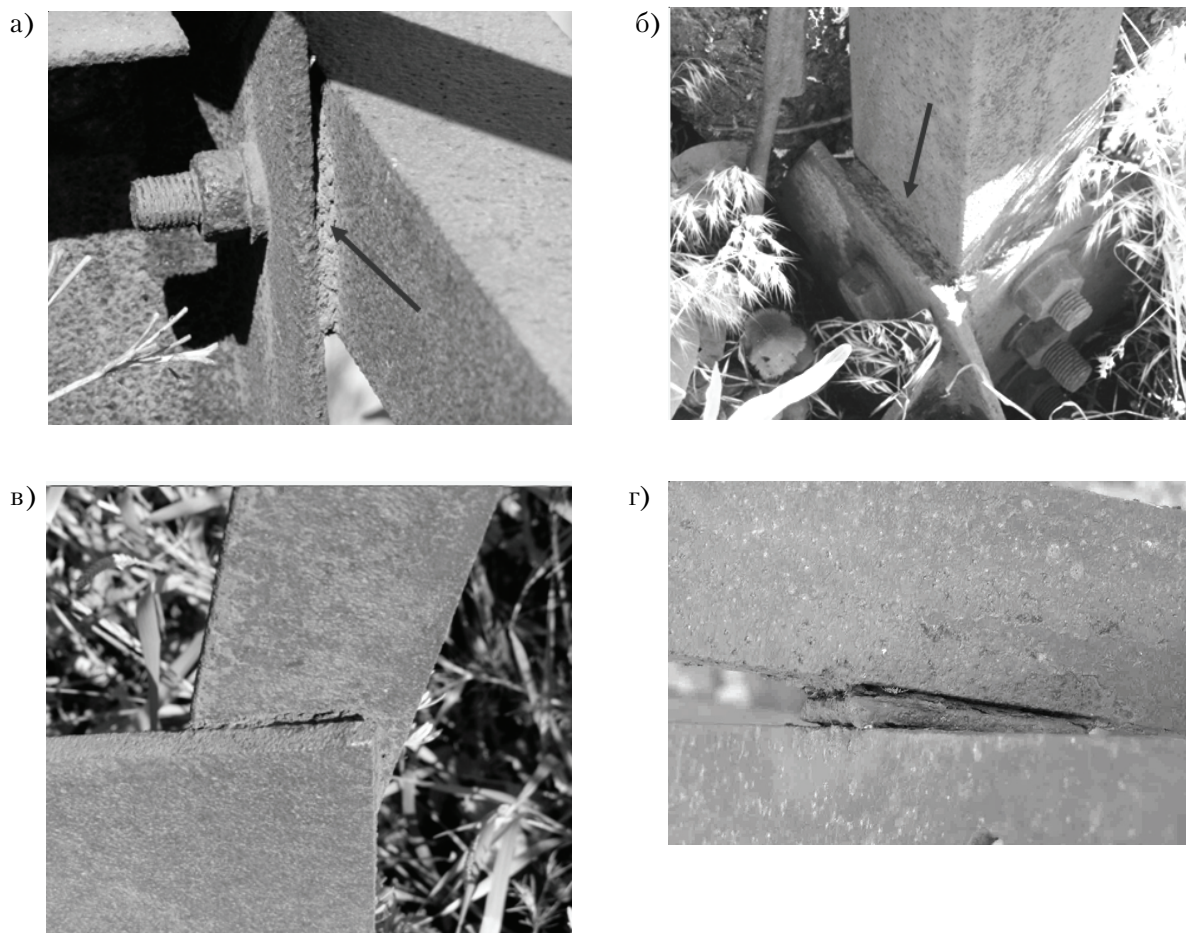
Щелевая коррозия в сварных и одноболтовых соединениях решетки опор: а – в болтовом узле крепления решетки; б – в узле стыка пояса с опорным башмаком; в – в узле крепления элемента на сварке; г – в сварных узлах перекрестной решетки.
